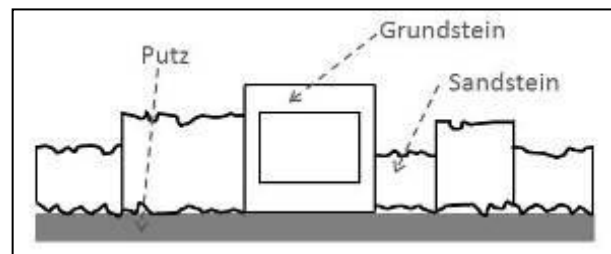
Schéma hypothèse de la structure des pierres et de la pierre fondatrice
